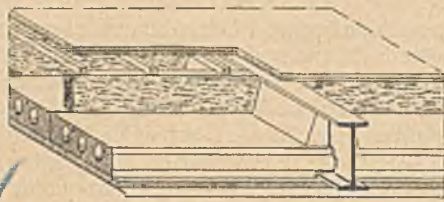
Nr. 105. K.Z. 791 091. Eisenbeton-Hohlbalken-Decke zwischen Stahlträgern. Richter & Schädel, G.m.b.H., Berlin. 1 : 40.
